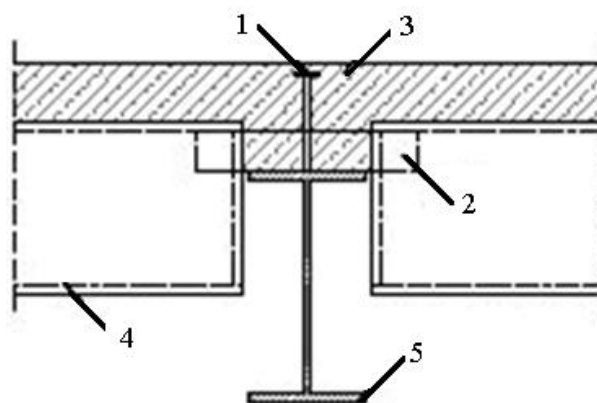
Минимальные размеры опорной площадки сталежелезобетонных плит
